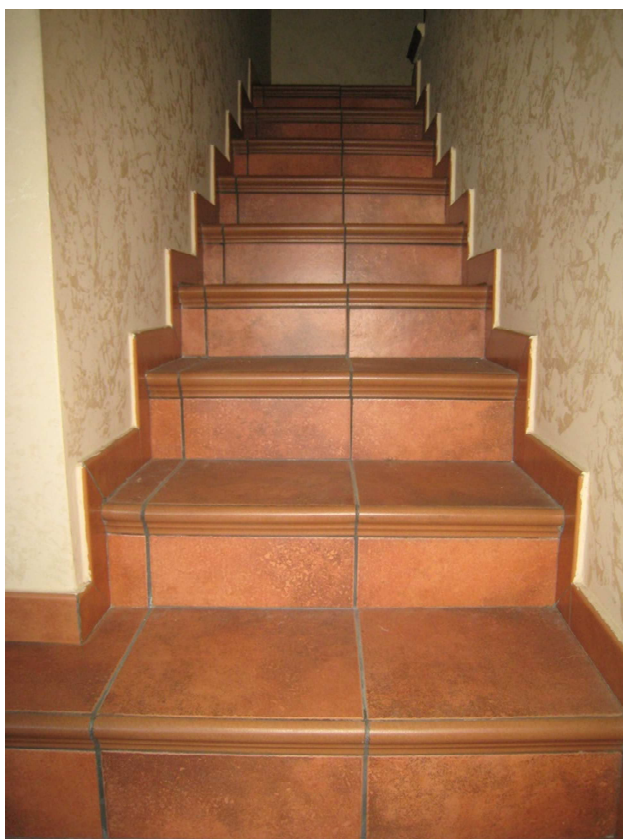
La seconda rampa di scale: 1°-2° piano.
